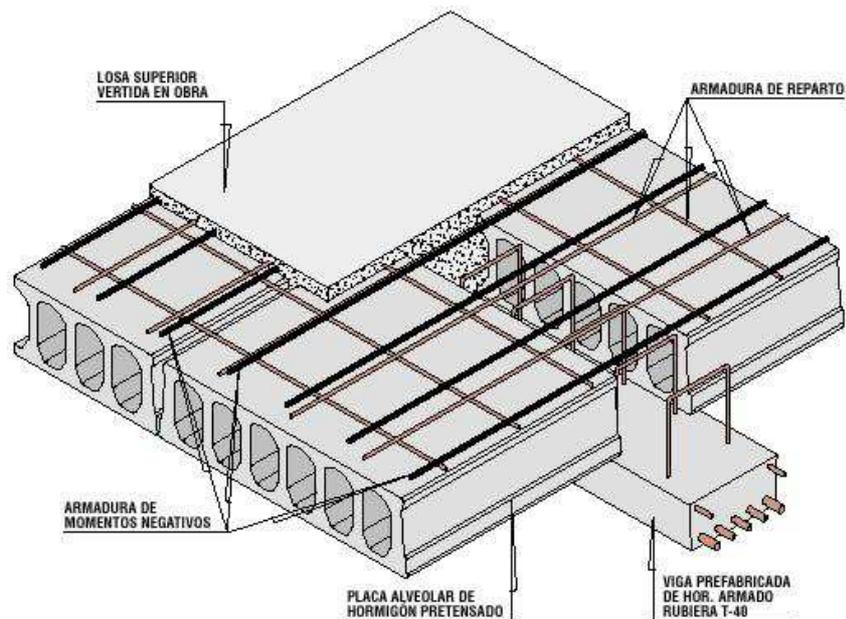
Estructuración de una losa de hormigón pretensado (A fine WordPress.com site, 2013)
